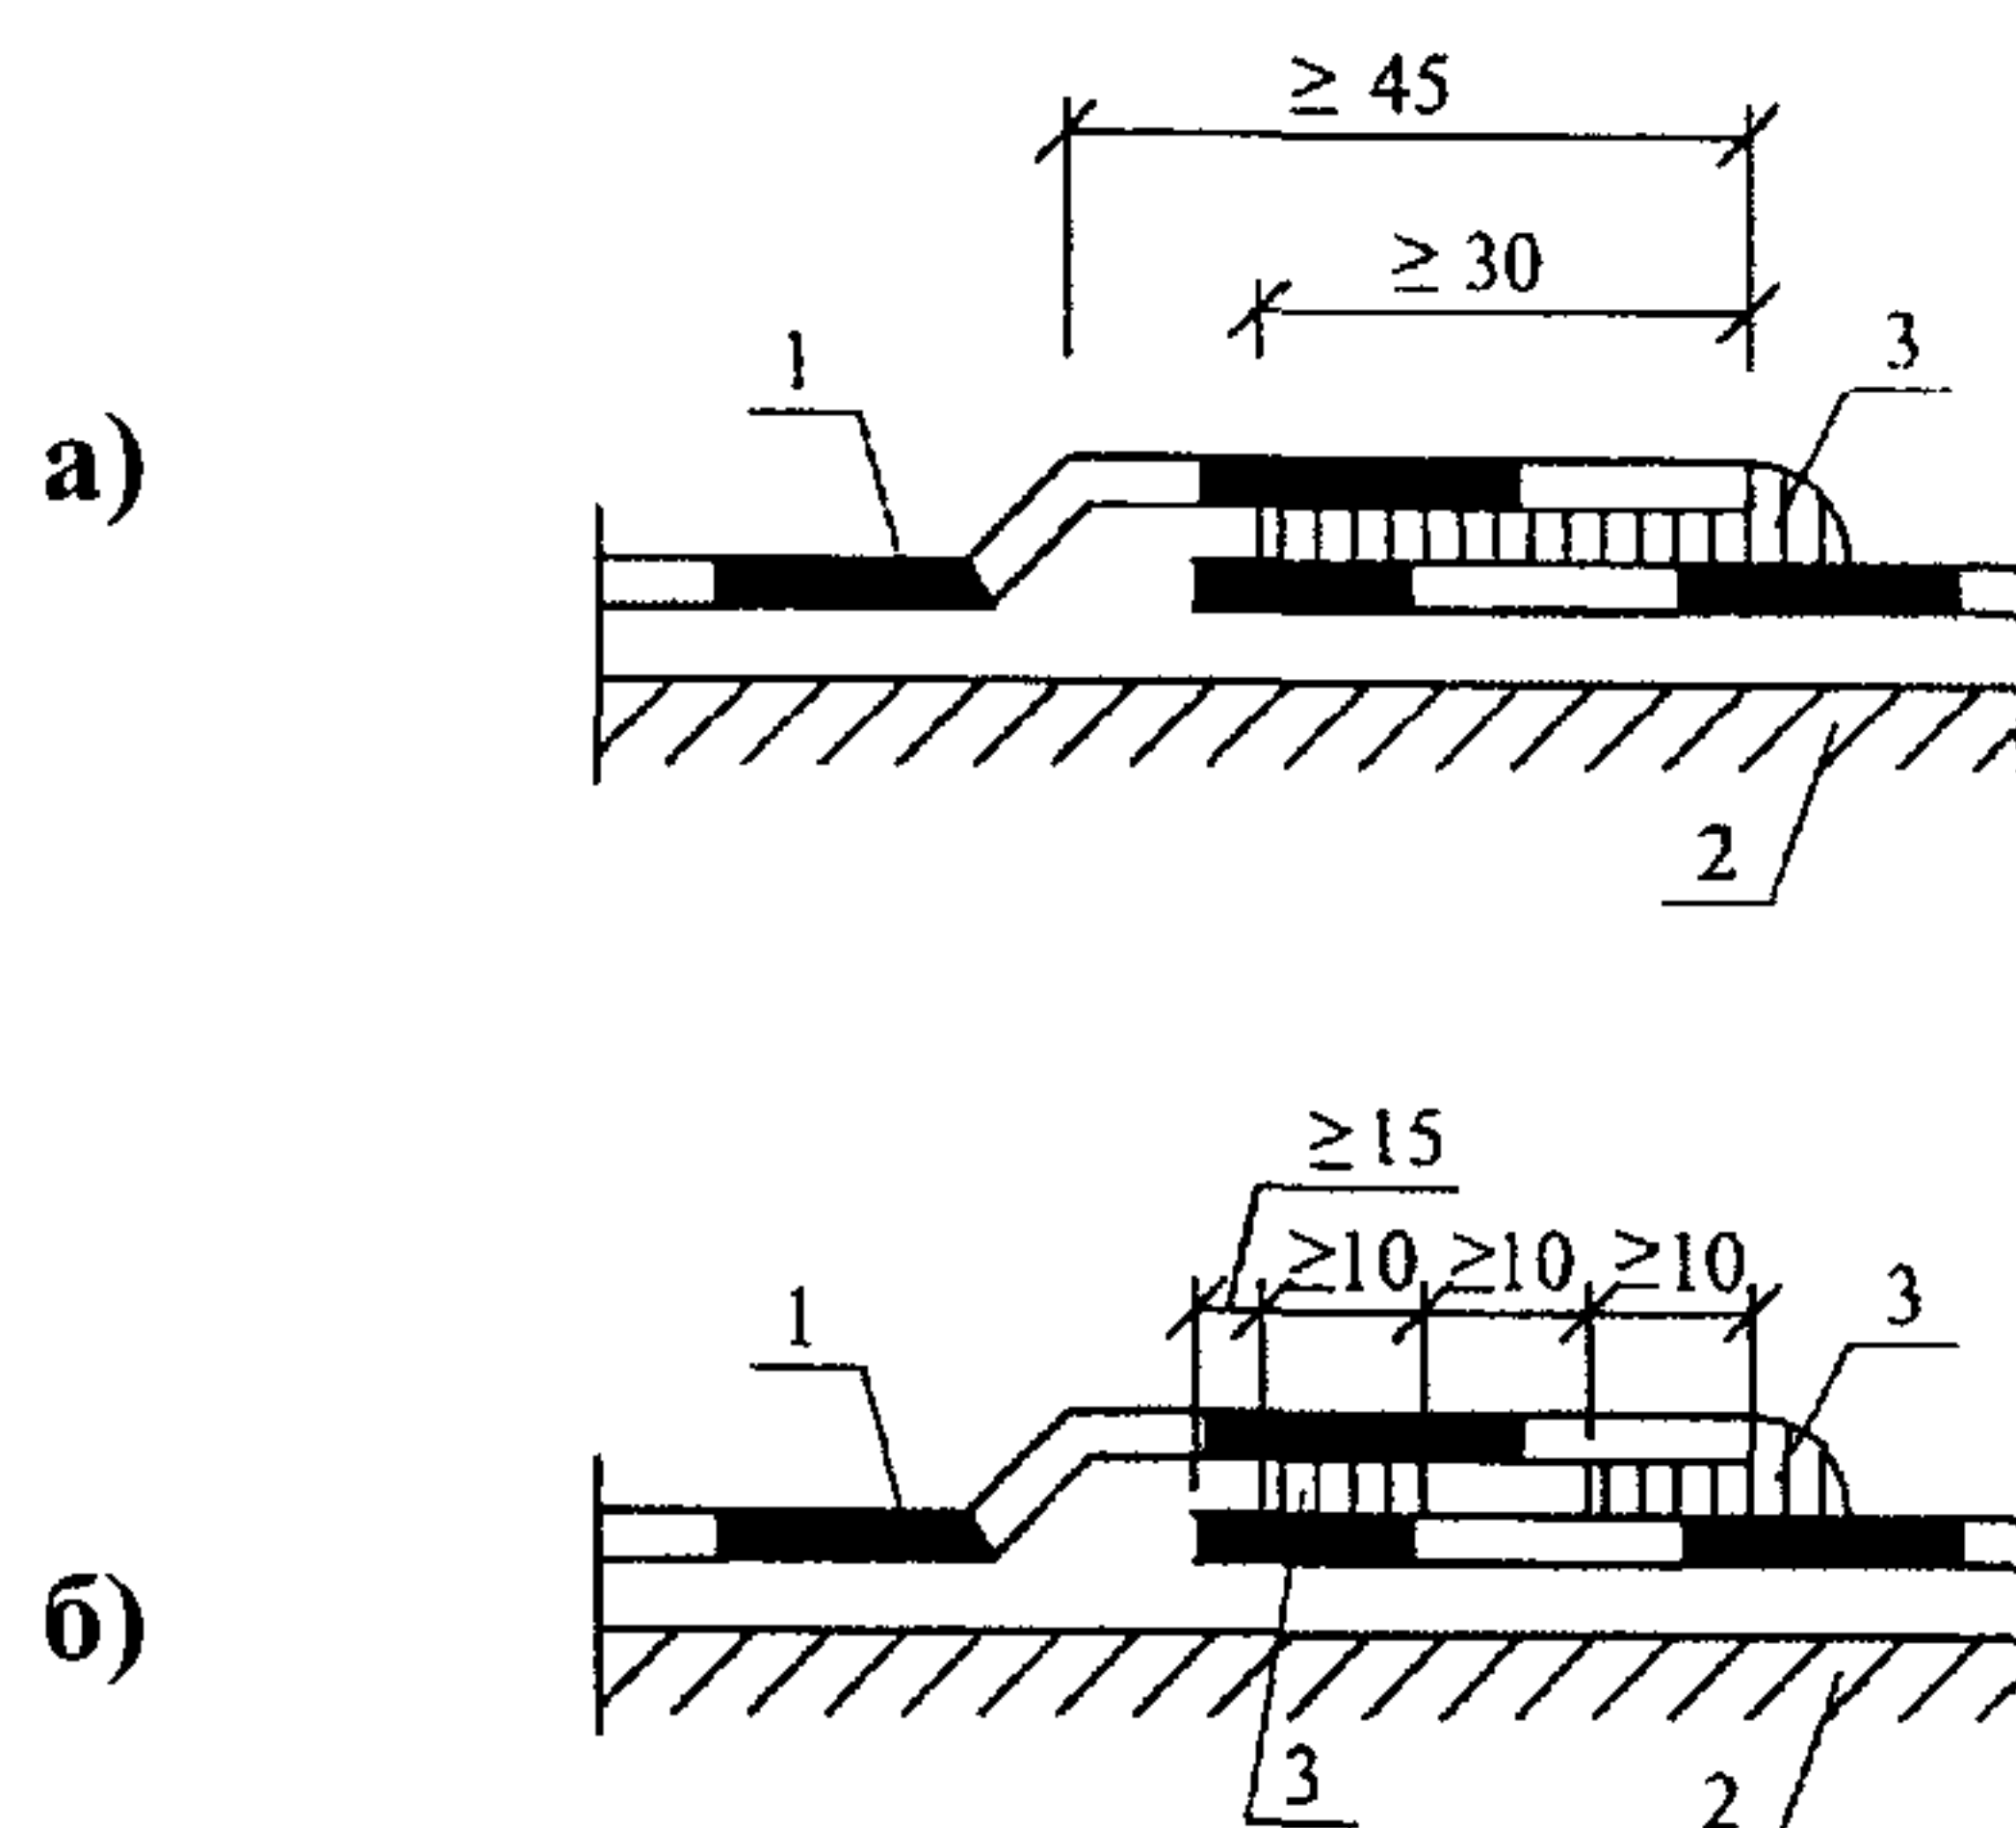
Сварной однорядный (а) и двурядный (б) шов полотнищ мембраны «ЮНИФОЛ»
